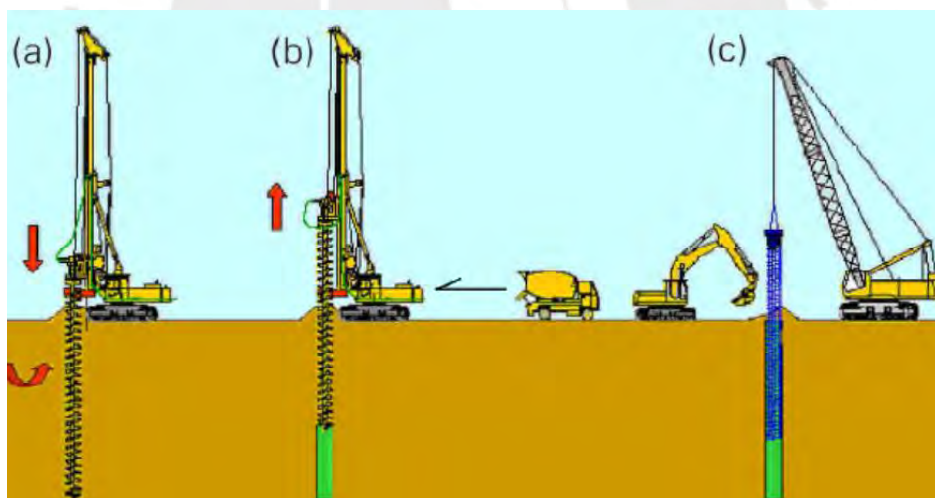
Proceso constructivo utilizando hélice continua. (Fuente: Pilotes Terratest. 2001)
